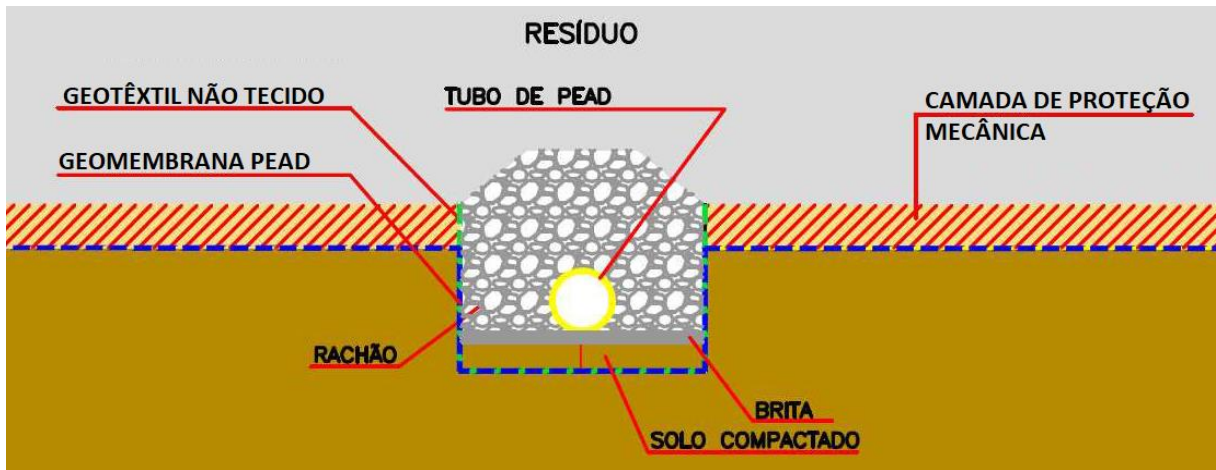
Croqui esquemático do dreno principal escavado no solo. Fonte: Autor.
